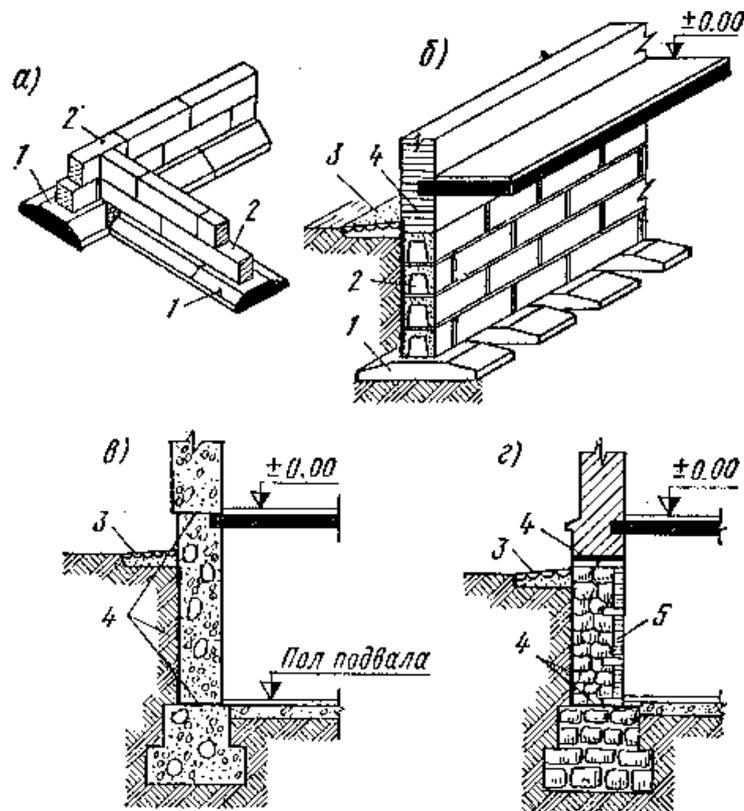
Конструкции ленточных фундаментов: а – сборный; б – то же, прерывистый; в – монолитный фундамент (бутобетонный); г – бутовый фундамент; 1 – фундаментные подушки; 2 – бетонные блоки; 3 – отмостка; 4 – гидроизоляция; 5 – кирпичная облицовка (в ½ кирпича)
